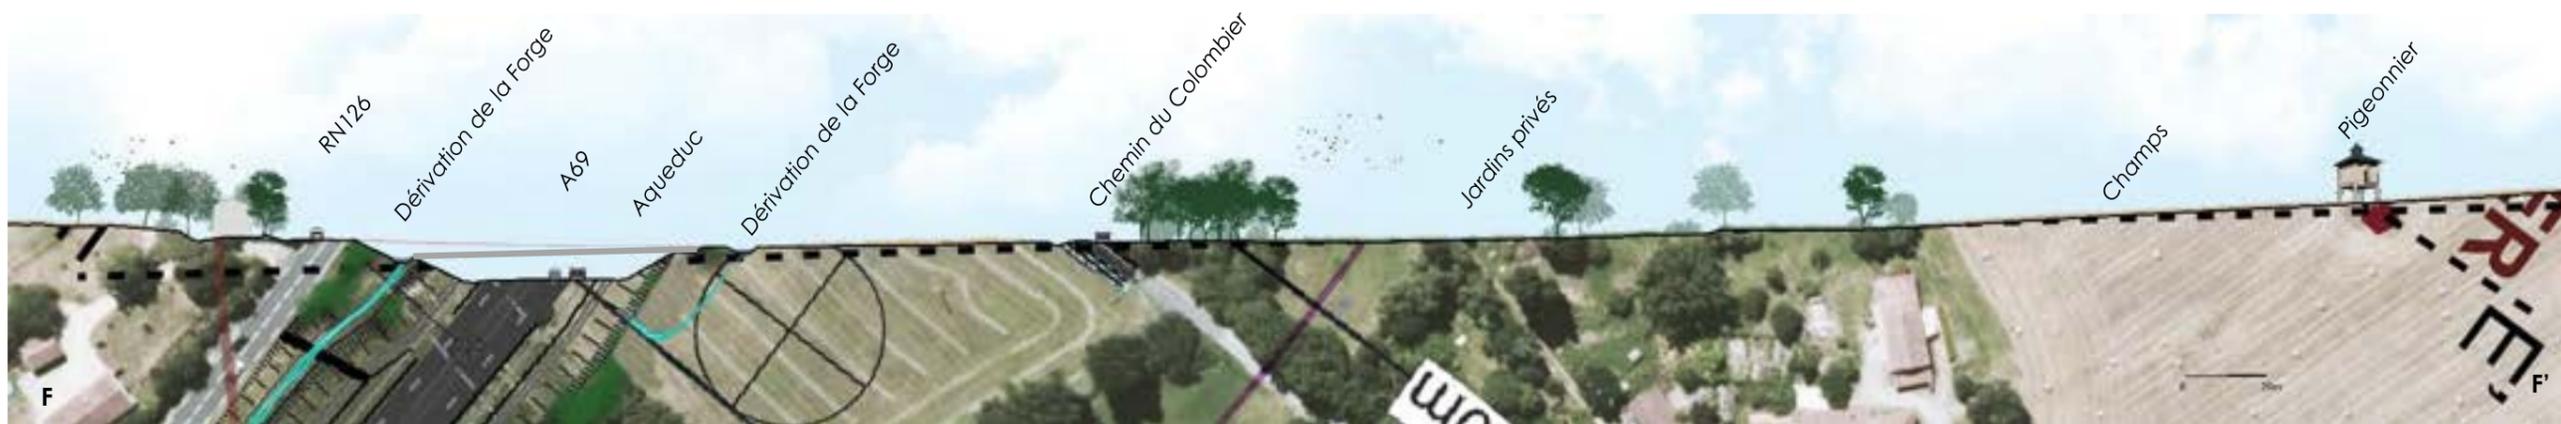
Coupe F – F' de l'implantation du projet dans le périmètre de protection du pigeonnier du colombier, PK 46+800, setec
